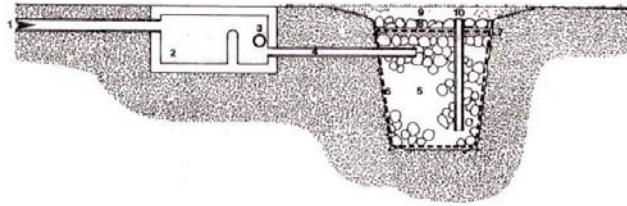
Elementos típicos de un pozo de infiltración. 1.- Alimentación por tubo (opcional), 2.- Decantador (opcional), 3.- Rebase (opcional), 4.- Tubería de conexión, 5.- Relleno, 6.- Geotextil, 7.- Filtro superficial (opcional), 8.- Cubierta superior, 9.- Alimentación superficial (opcional), 10.- Piezómetro.
